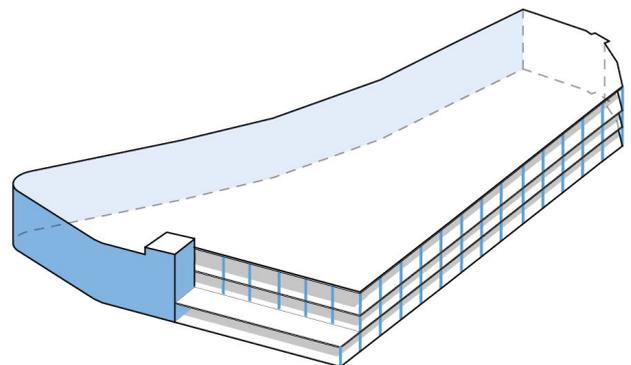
Posición en la volumetría de la fachada cerrada y la fachada abierta.
